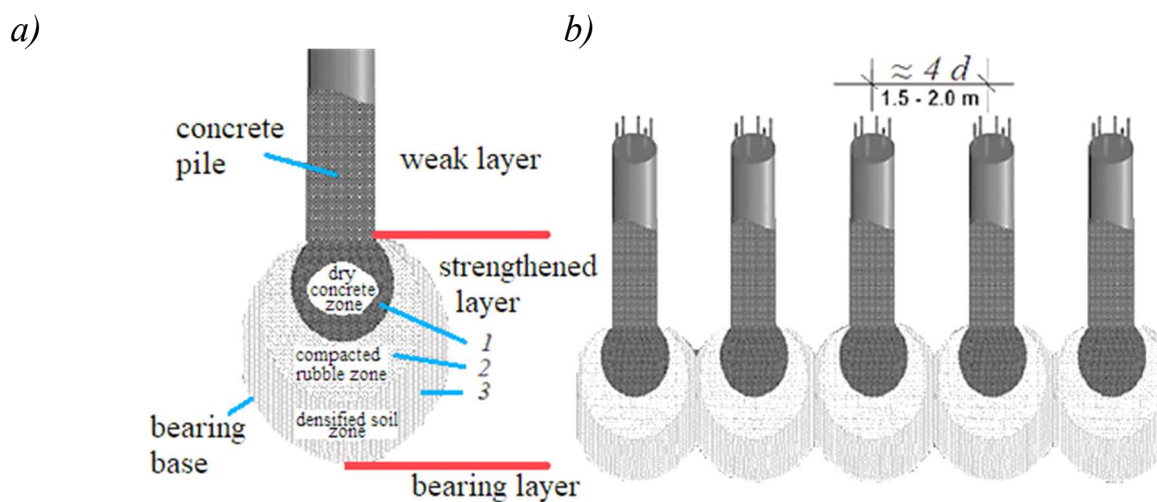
Конструкція RBB паль [101]: *a* – будова ущільненої несучої основи; *b* – ефективне розташування групи RBB паль у фундаменті; 1 – піщано-гравійна або суха бетонна суміш; 2 – будівельне сміття (бетон, щебінь, цегла, промислова зола); 3 – ущільнений ґрунт.
